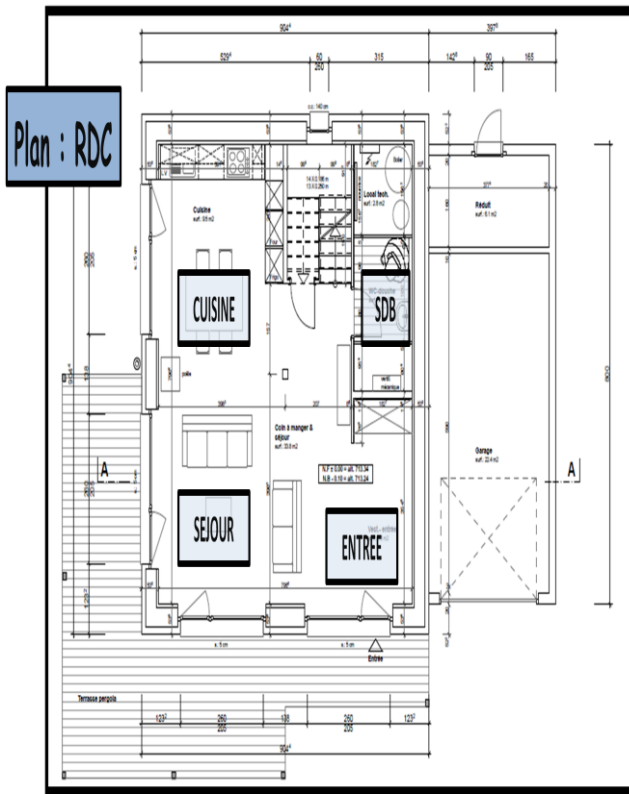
Plan RDC, Source : <http://lab-immo.ch/1037/> Minergie-P-ECO MAISON
